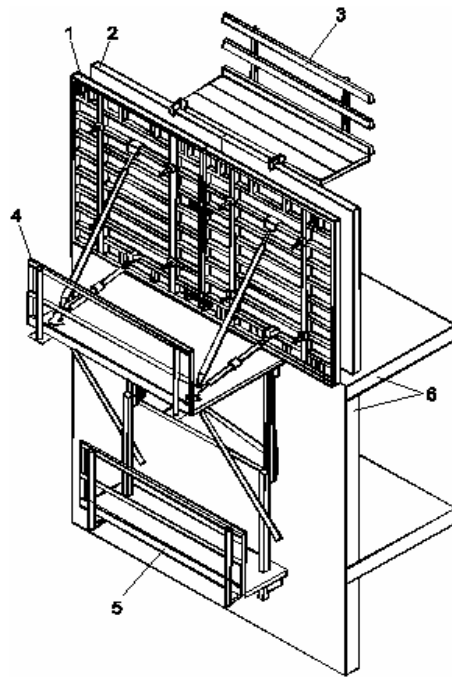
Схема устройства подъемно-переставной опалубки наружных стен:
